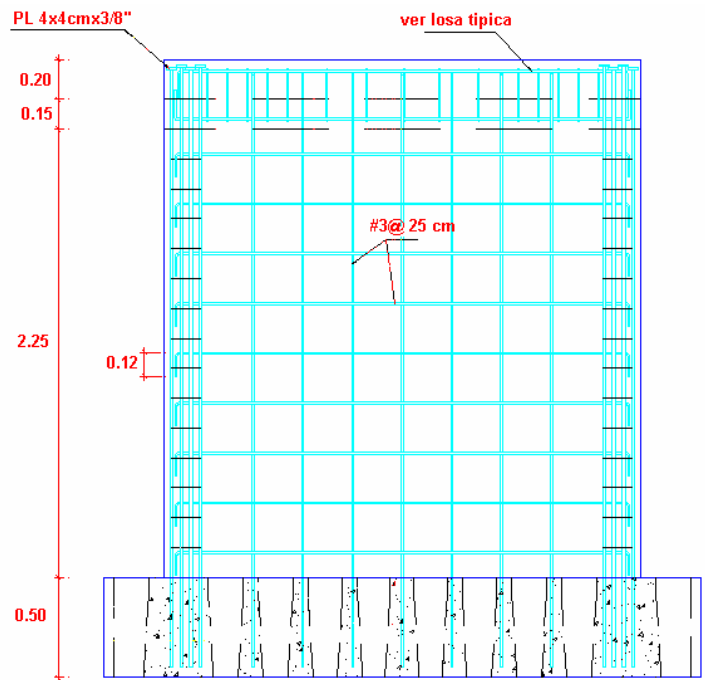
Detalles constructivos muro MCC50M y MCC50C
